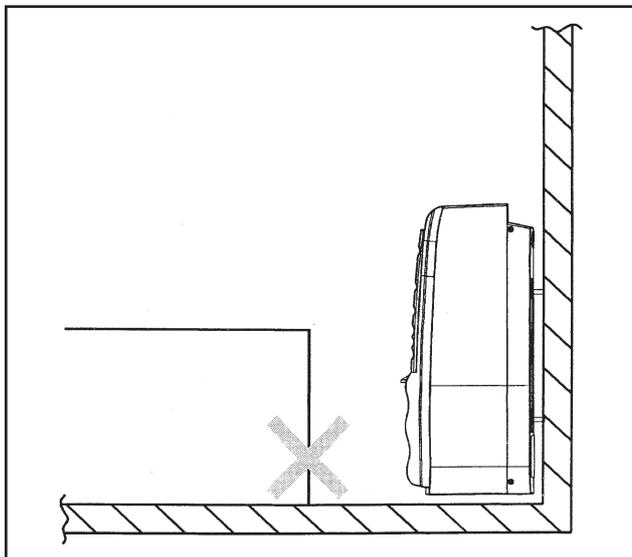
MONTAGEM DO PISO - CONSOLE
